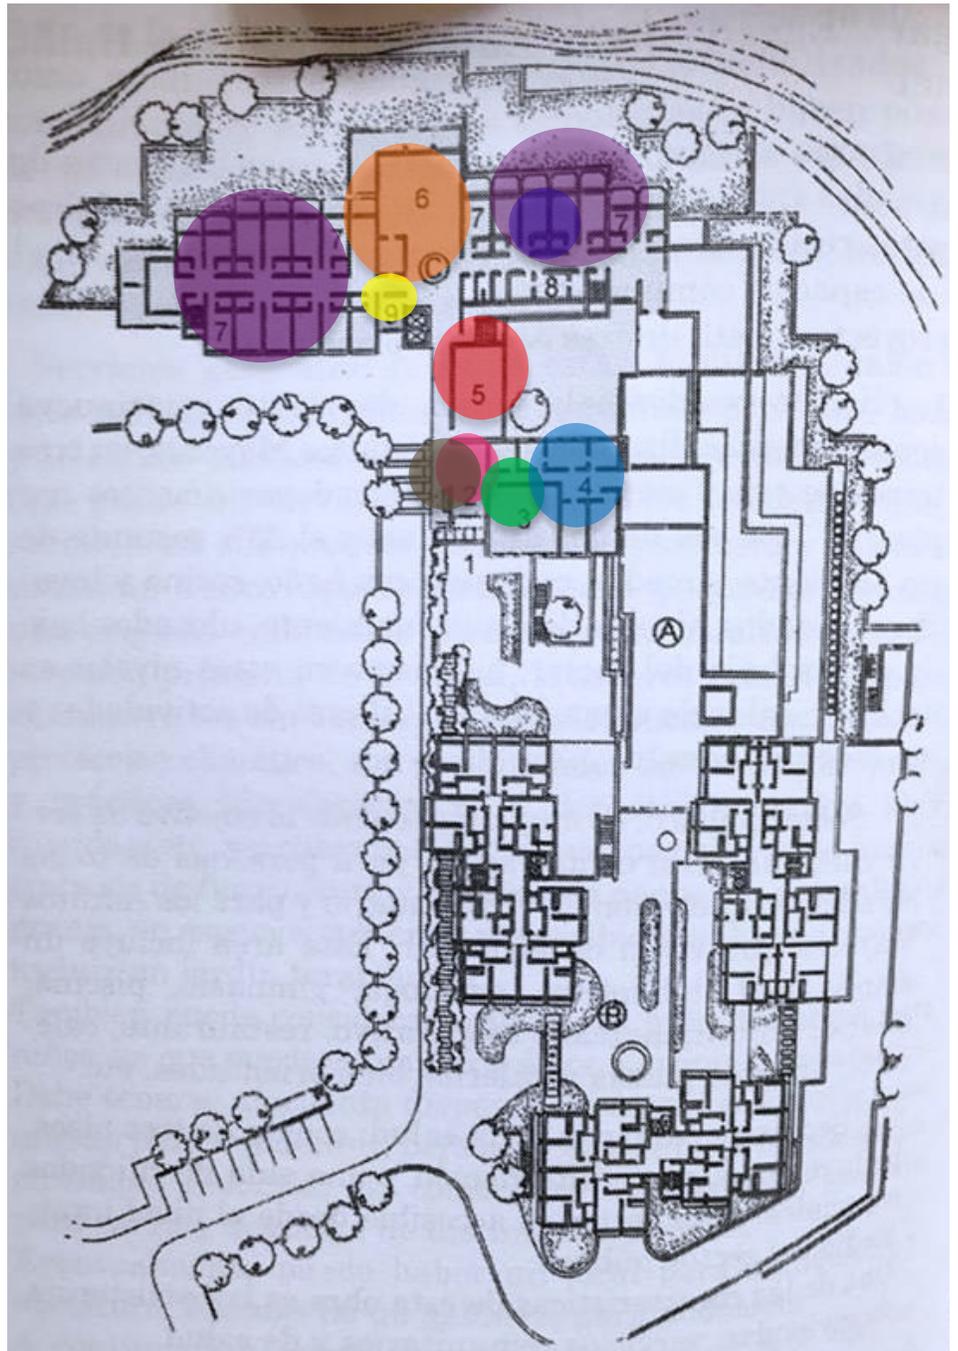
Planta arquitectónica de Hogar “EGGED”.
